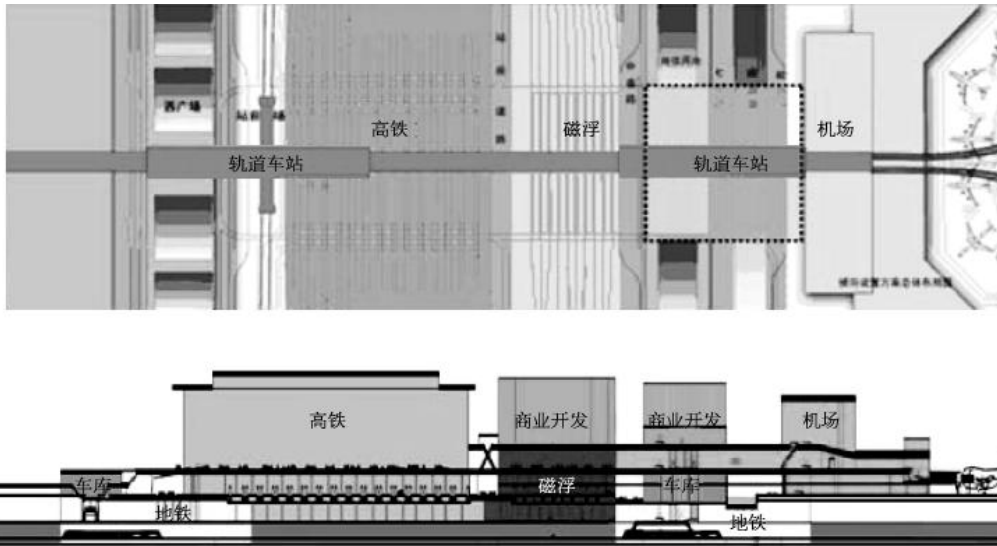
虹桥综合交通枢纽核心区建筑平面及竖向层面布置图
